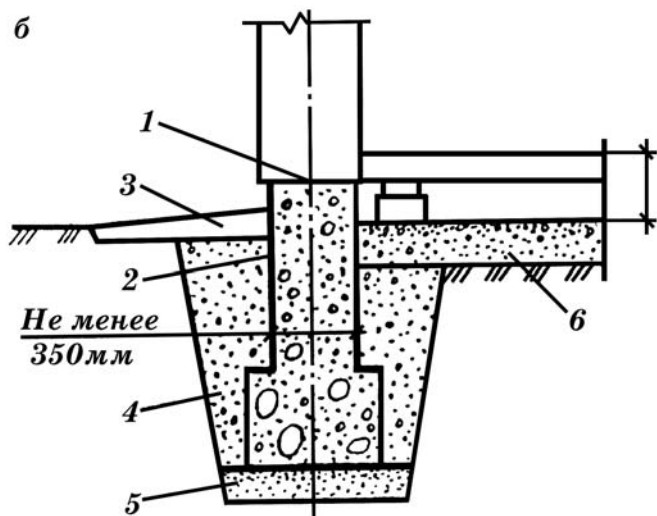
Ленточные фундаменты из бутобетона и монолитного бетона: б – бутобетонные ленточные с заглублением на глубину промерзания грунта: 1 – гидроизоляция из двух слоев рубероида на битумной мастике; 2 – обмазка горячим битумом за два раза; 3 – отмостка; 4 – обратная засыпка; 5 – песчаная подушка; 6 – утрамбованный грунт со щебнем; 7 – гидроизоляция: цементный раствор состава 1:2; 8 – пол подвала или уплотненный грунт для технического подполья.
